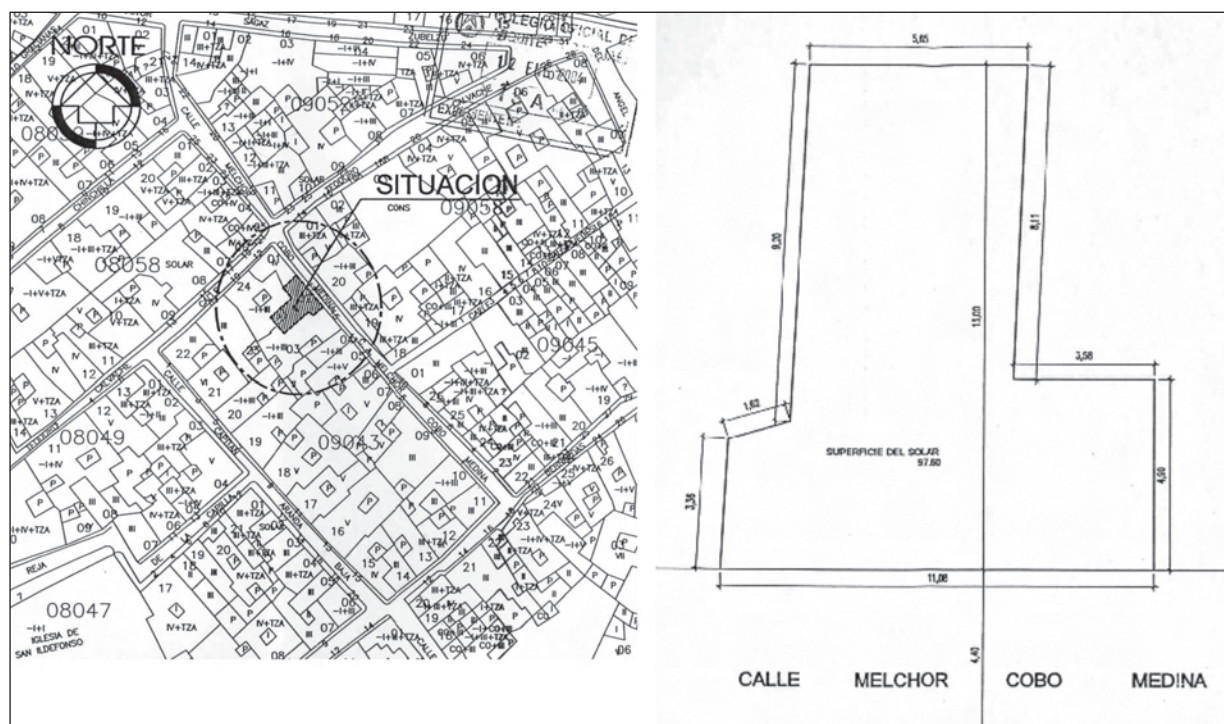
Situación y planta de la parcela nº 17, de la C/ Melchor Cobo Medina. Jaén
